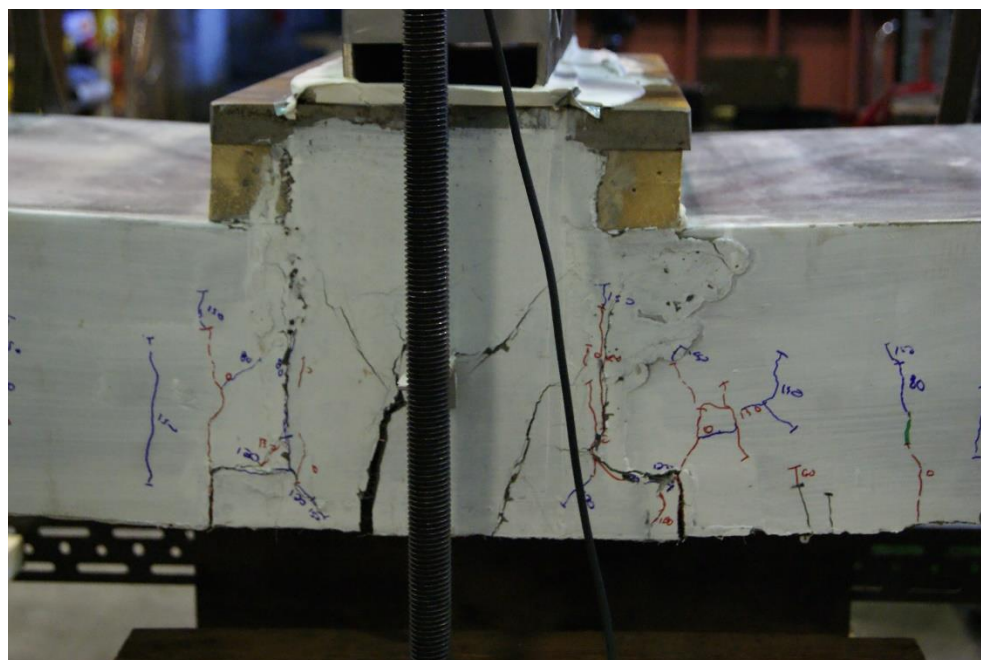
Fissuration au niveau du joint du spécimen avec de petites ailes (S2-PA)
